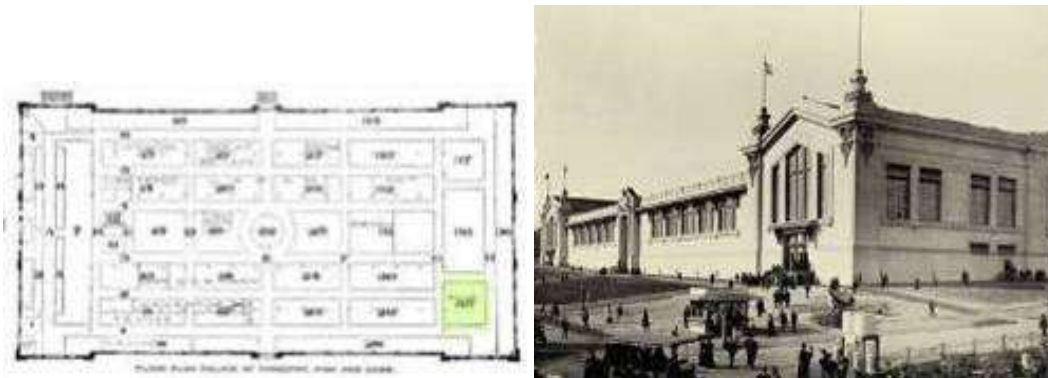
Palácio dos Recursos Florestais, Caça e Pesca (Fonte: planta - Oficial Guide L. P. E. - imagem M.H.M.)
